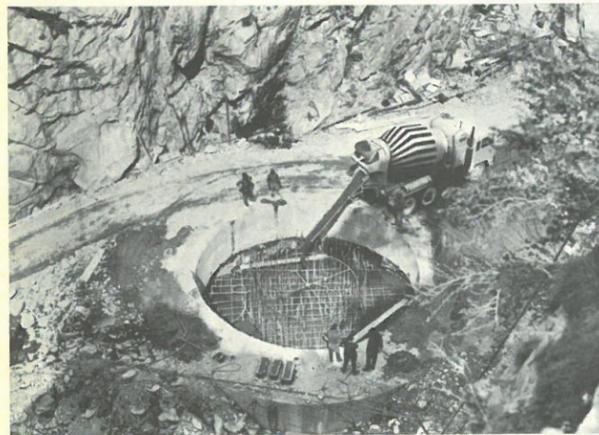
Fase di getto della fondazione di una delle pile trattate.
